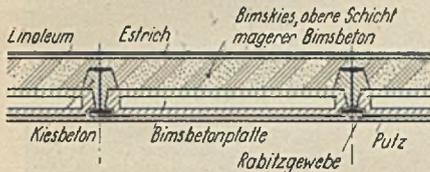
Deckenausbildung beim Stahlskelettwohnungsbau Becker, Köln.
